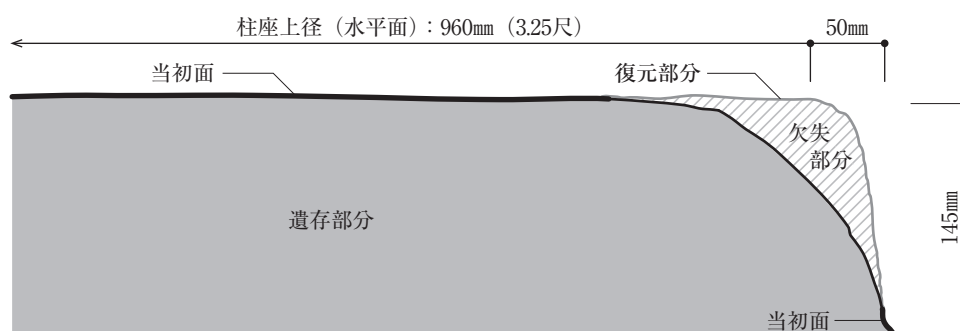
出土礎石片 復元柱座断面図 1:5
